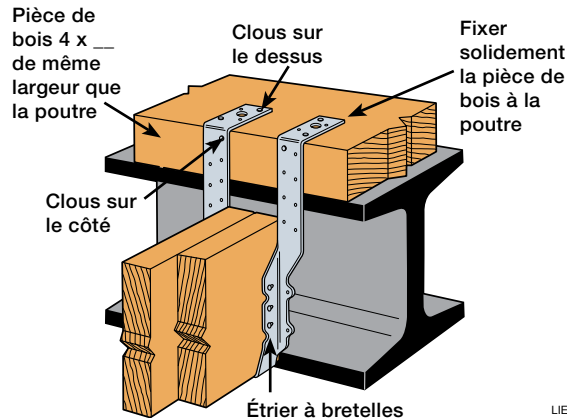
• Étrier à bretelles (Image: Simpson Strong-Tie)
